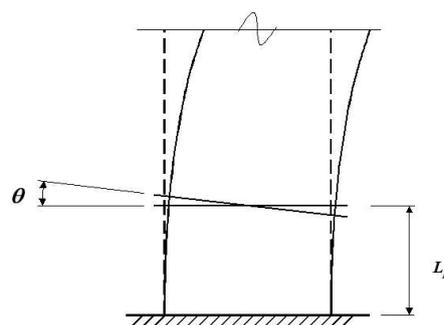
Rotación de articulación plástica donde la flexión controla la respuesta inelástica
